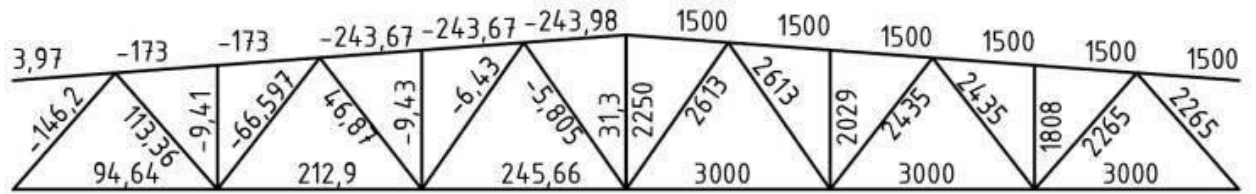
Геометрична схема кроквяної ферми
